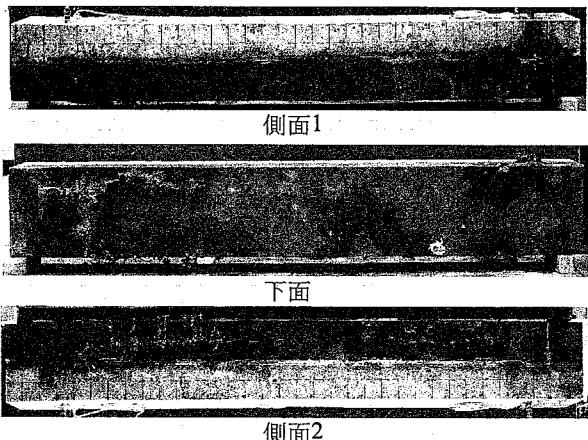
腐食痕とひび割れの発生位置(電食期間135日)
